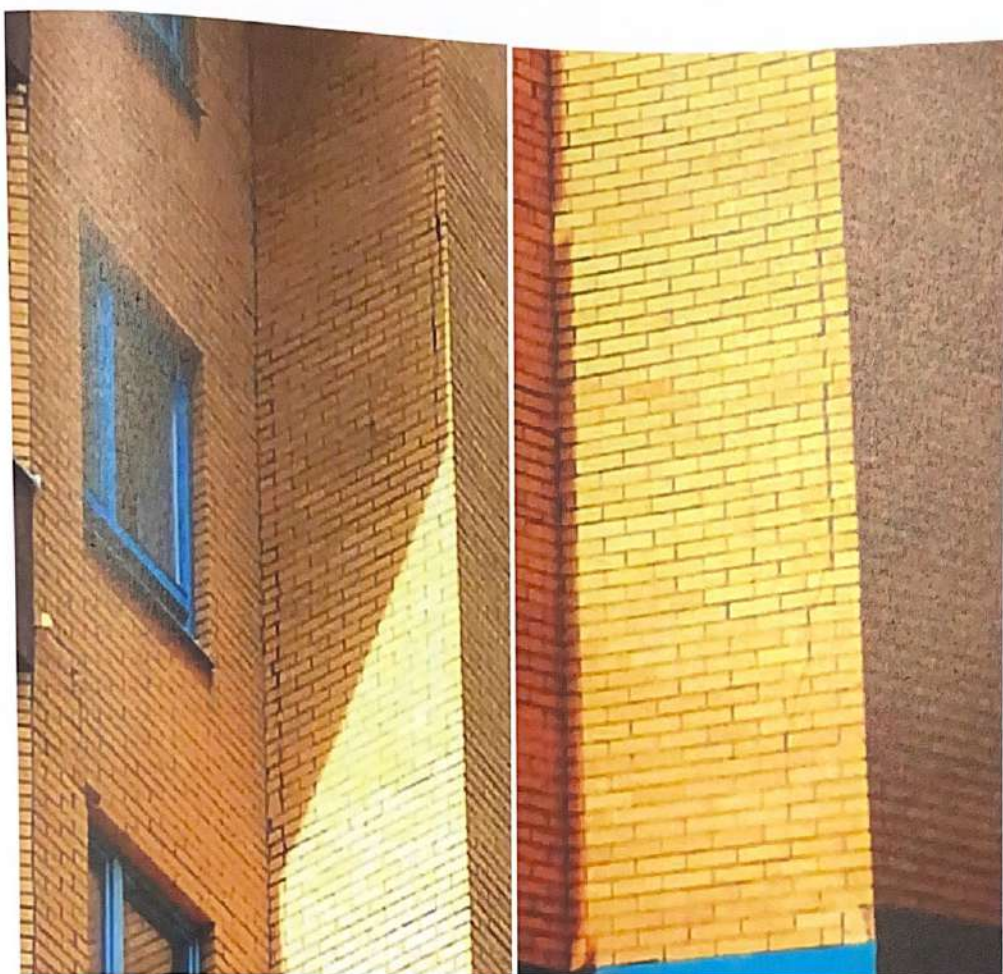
Секция 7. Трансэтажные вертикальные трещины по наружной версте.
